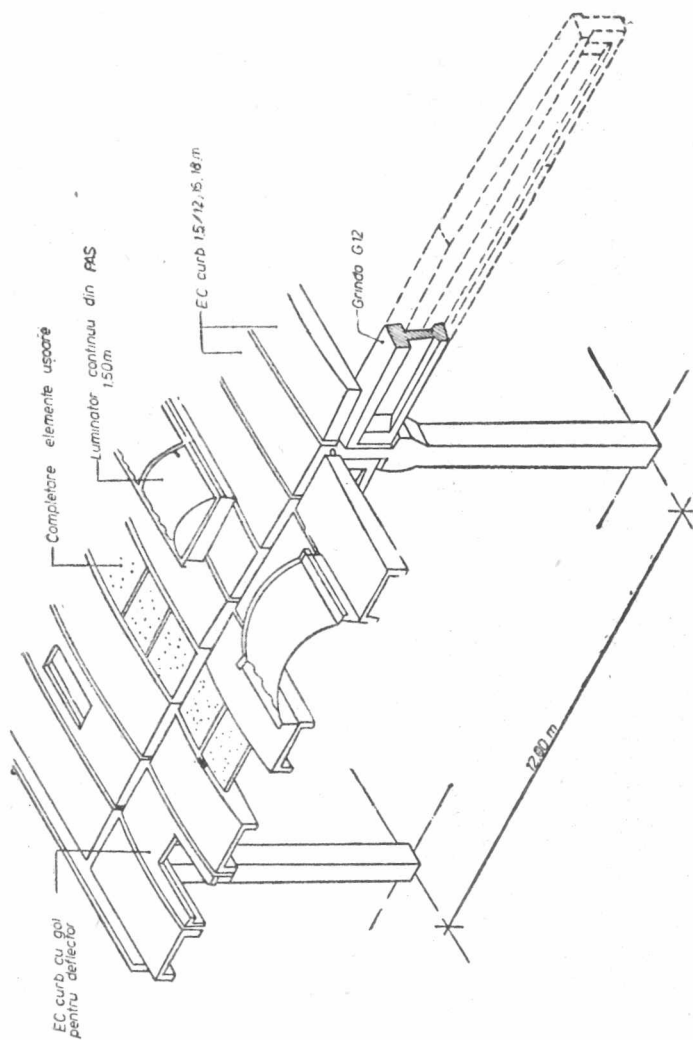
b. Hală cu grinzi din beton precomprimat și elemente de suprafață curbe cu goluri.
